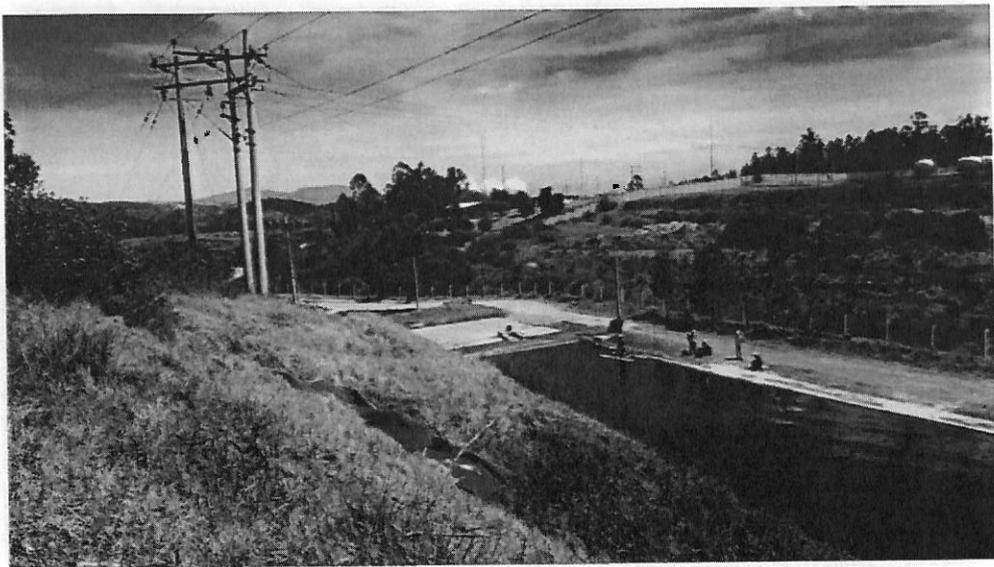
Postes de luz en área de influencia de construcción del Cubeto 10
